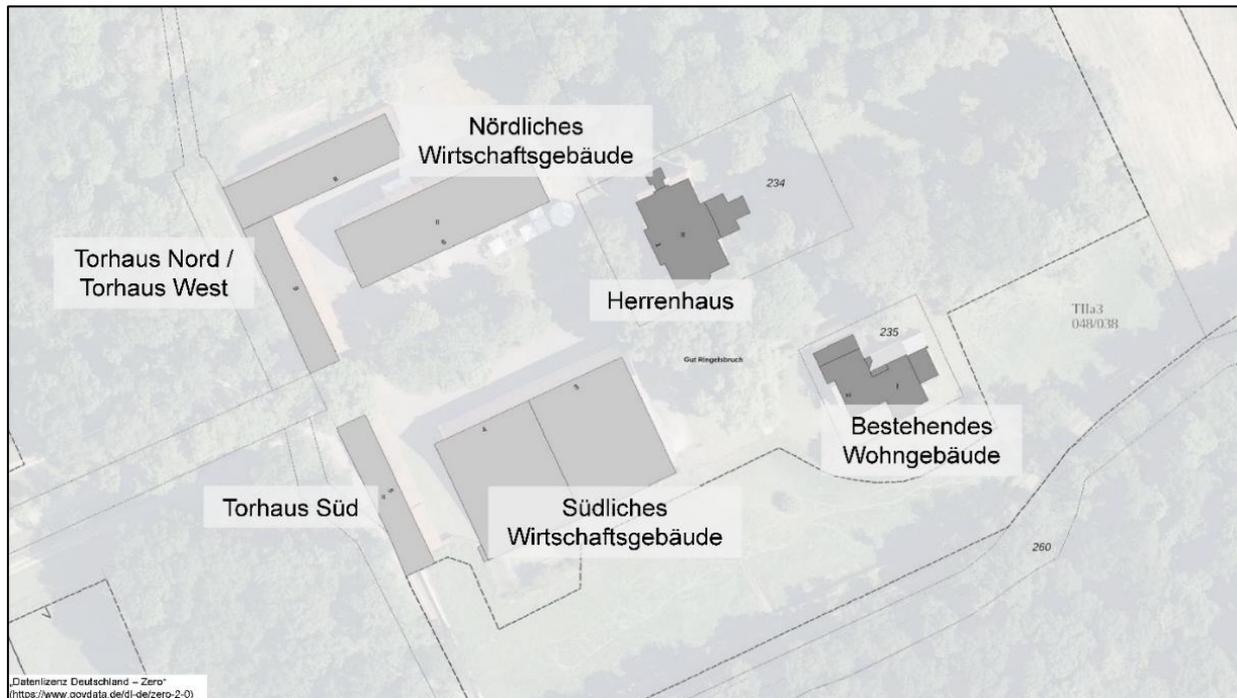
Lageplan mit bestehender Bebauung des Gutes Ringelsbruch o. M.
